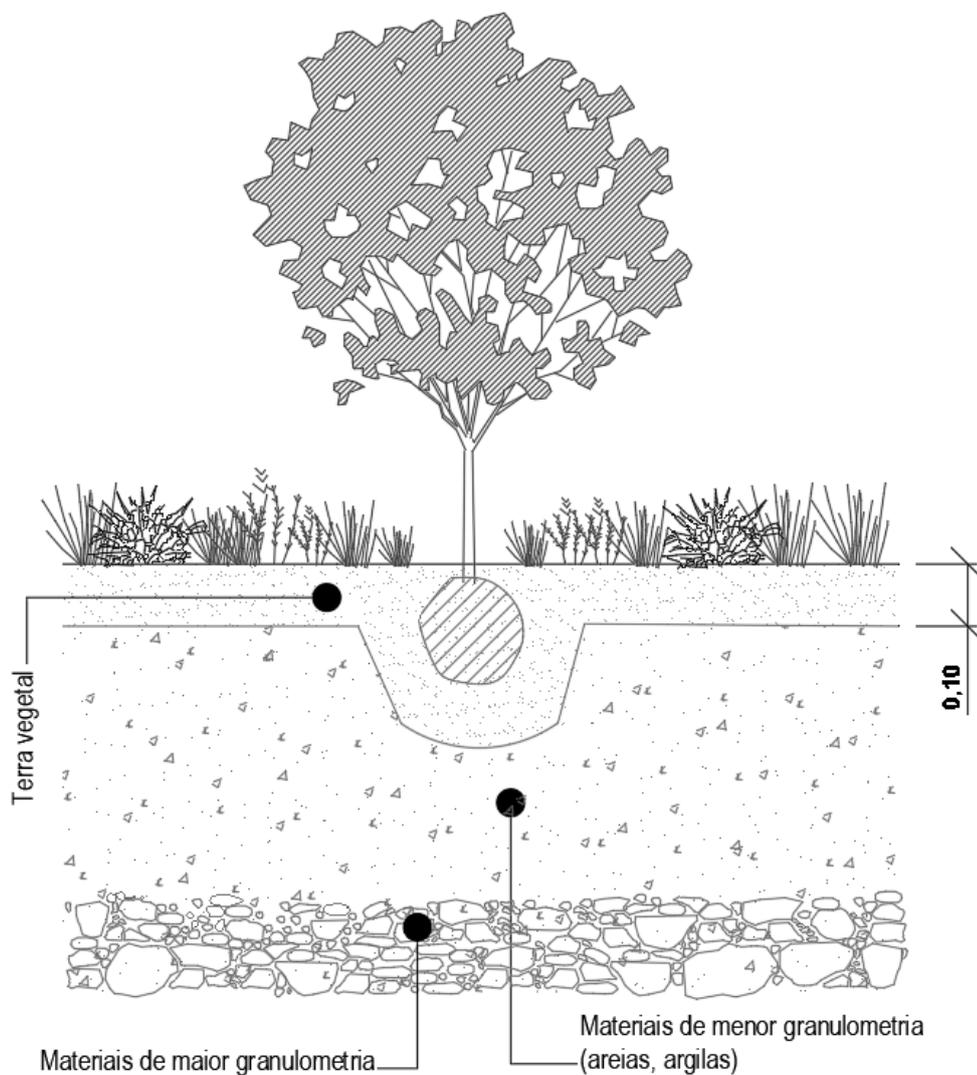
Desenho esquemático da metodologia de plantação, camada e bolsas de terra vegetal para as plantações e sementeiras.
